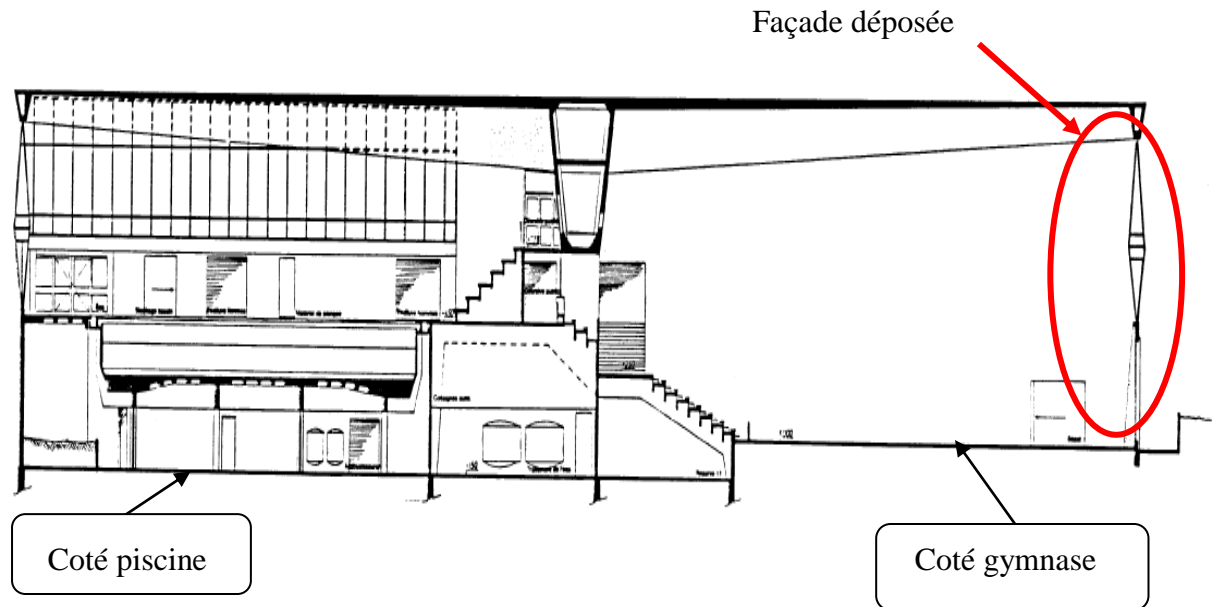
Coupe transversale sur Bassin et Gymnase
